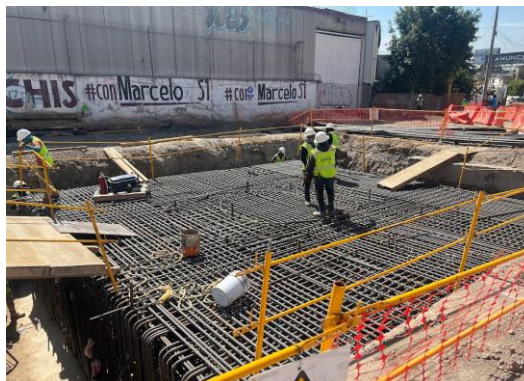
y 102 Autoría Propia (2023) "Vista de los trabajos de armado de acero en zapatas de Apoyos Intermedios"
